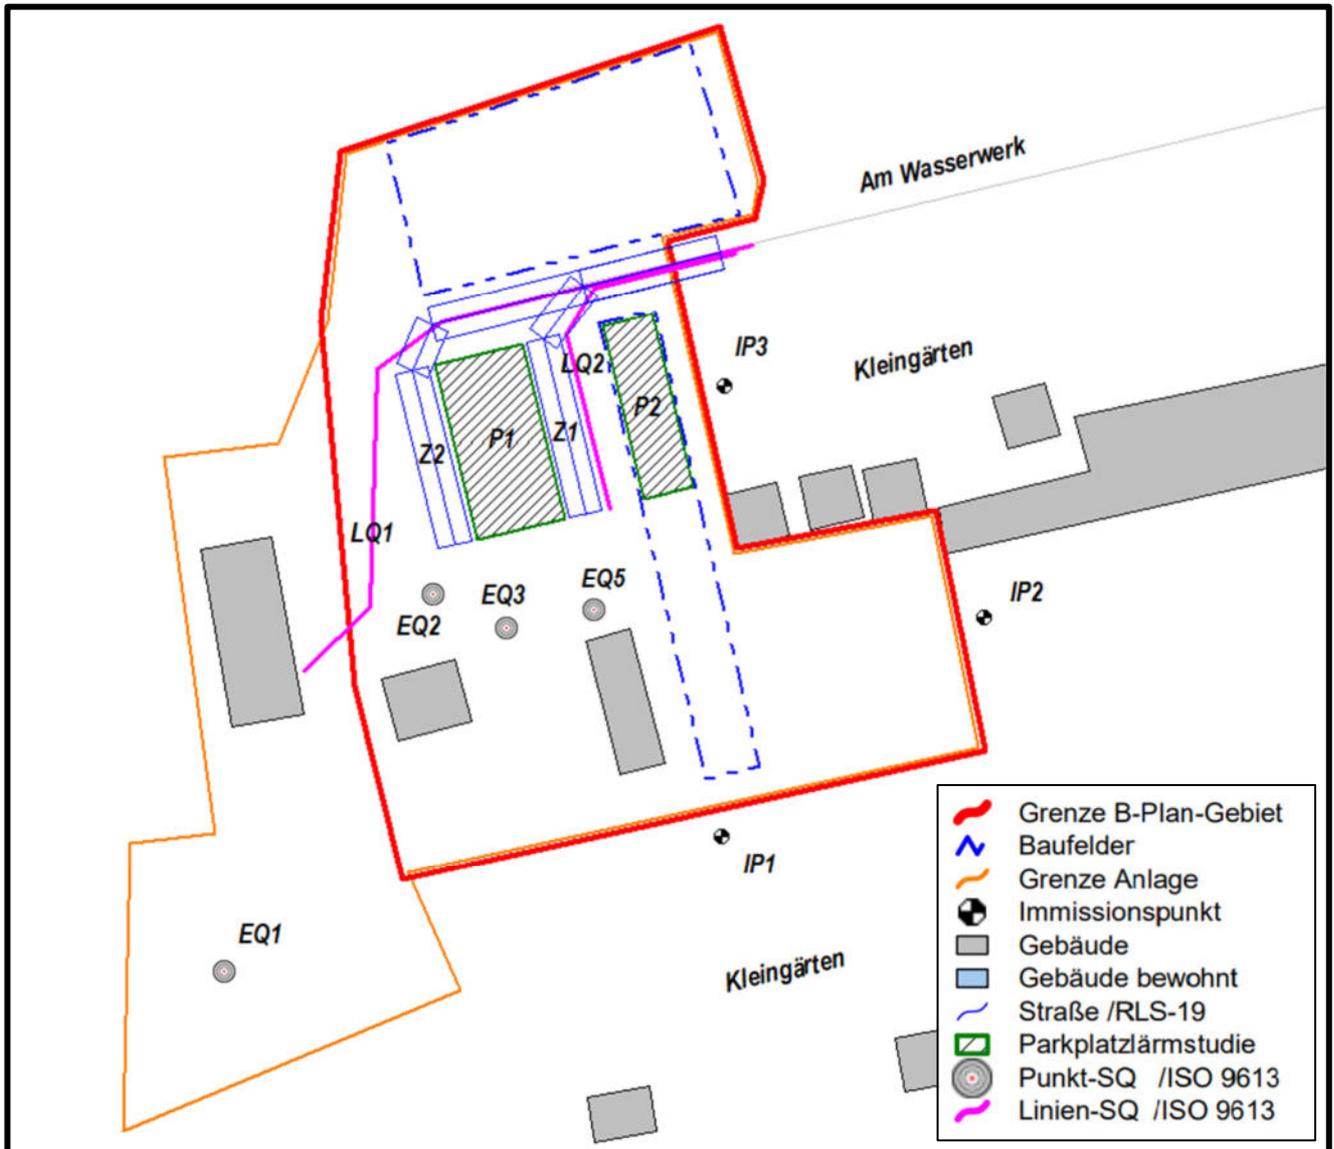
Lageplan Schallquellen beim geplanten Regelbetrieb des Bauhofs Taucha
